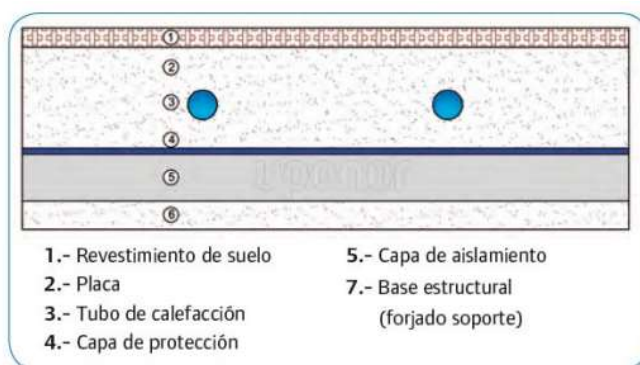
Estructura piso refrescante (UNE-UN-1264:2009)
